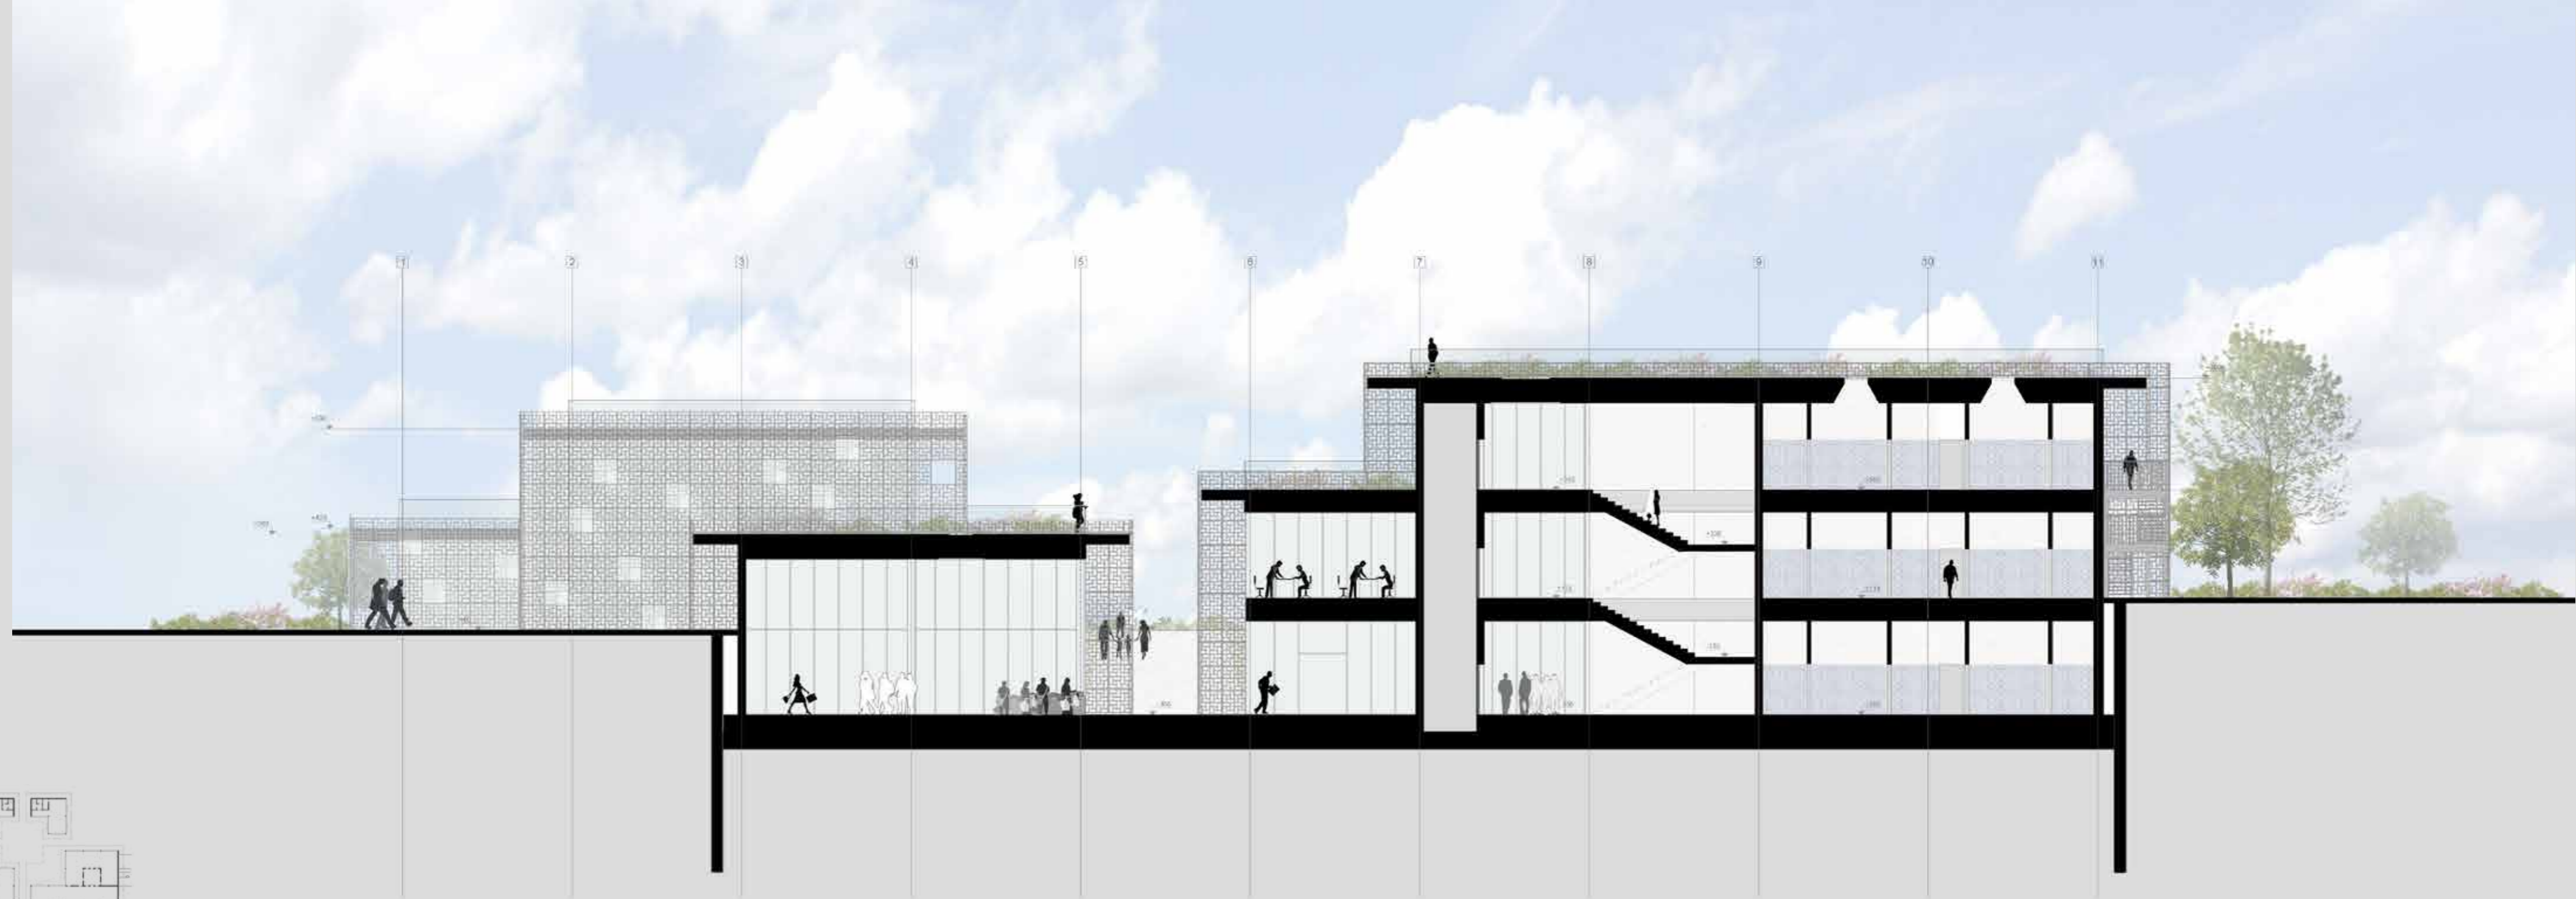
Sezione verticale A-A - Scala: 1:200
